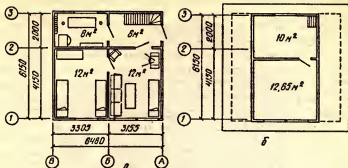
Планы 1-го этажа (а) и мансарды (б)
